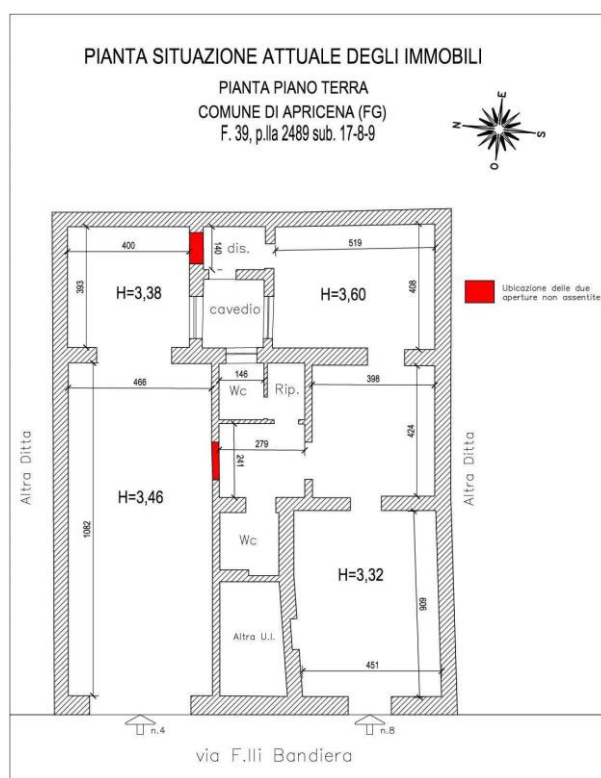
Pianta immobili pignorati con ubicazione delle due aperture non assentite.
